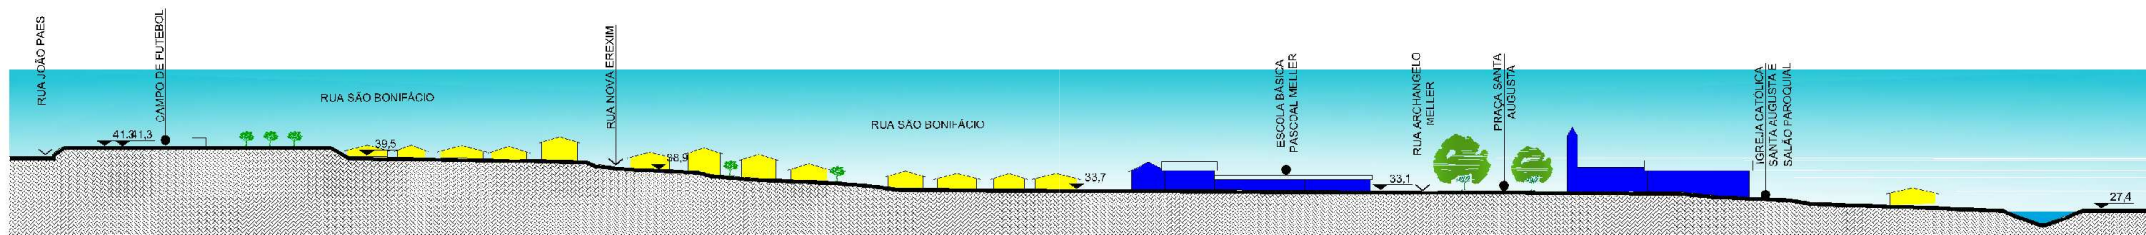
Corte Esquemático 03 – Rua São Bonifácio
